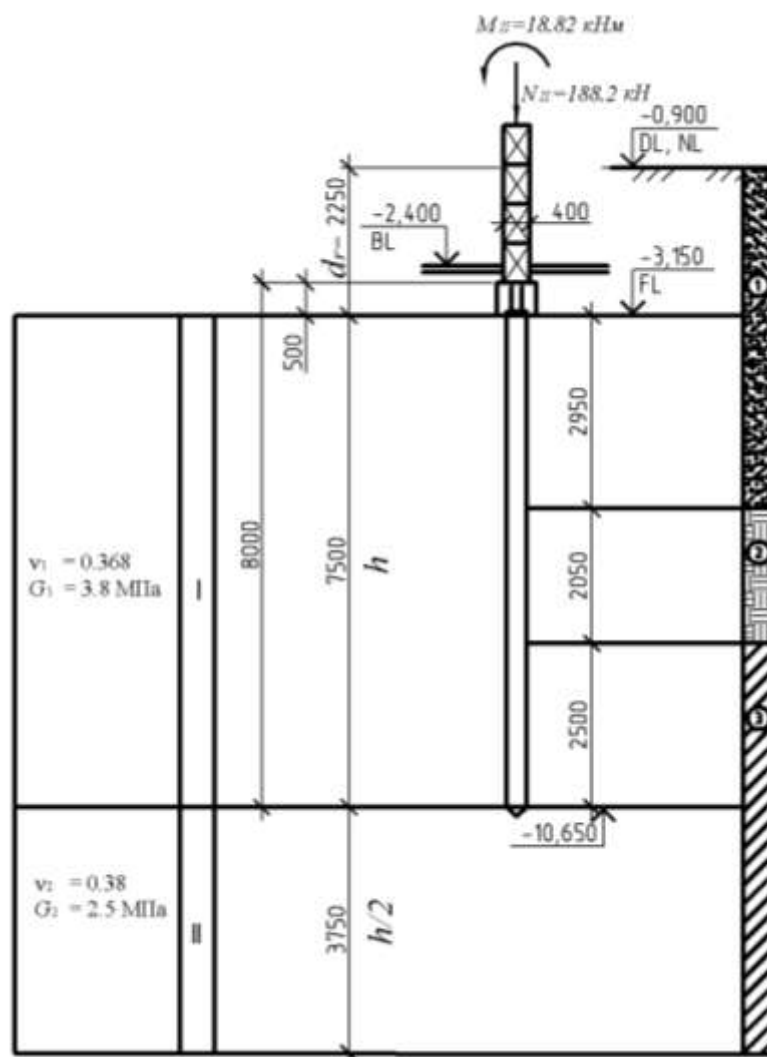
Расчетная схема к примеру 9.2.1
